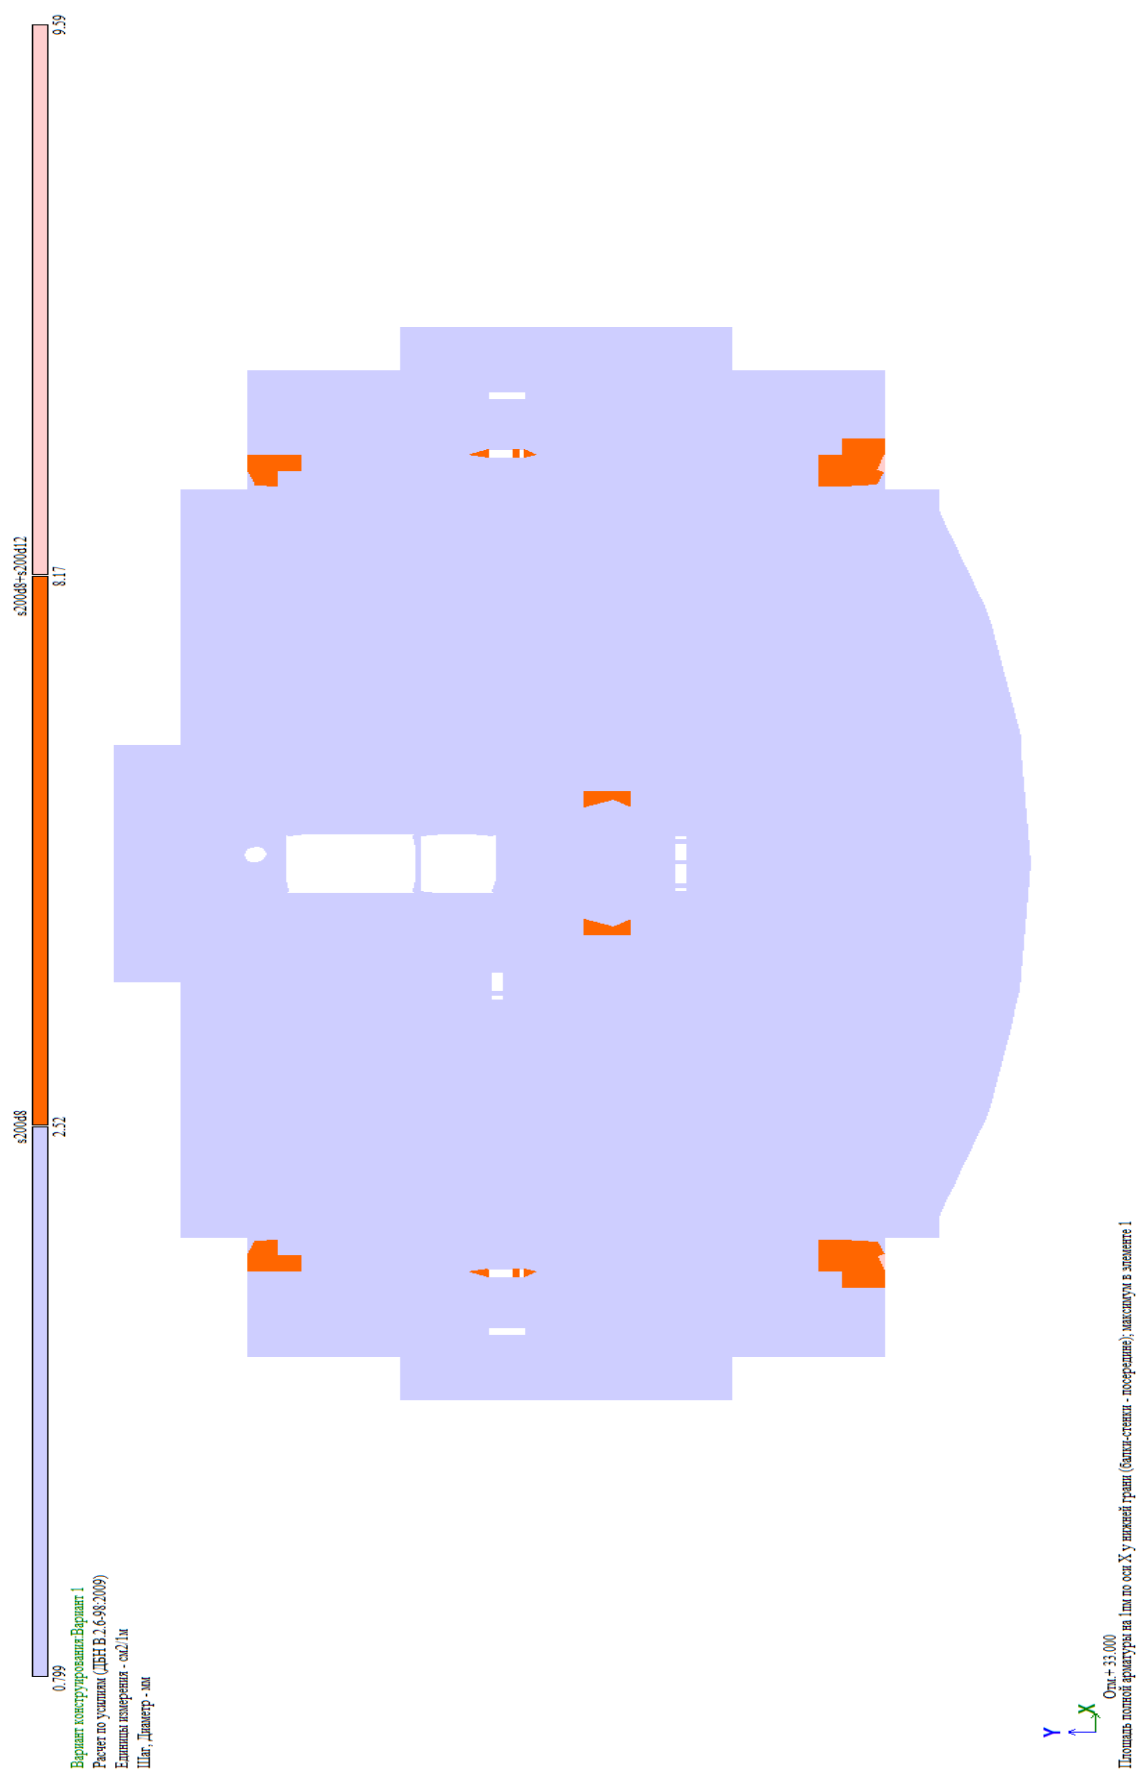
Розташування поздовжньої арматури по осі X у нижній зоні
